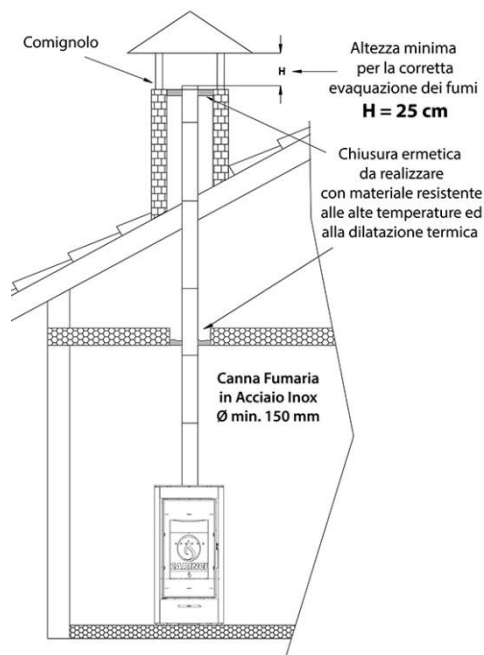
Collegamento della stufa AIR WOOD alla canna fumaria.
